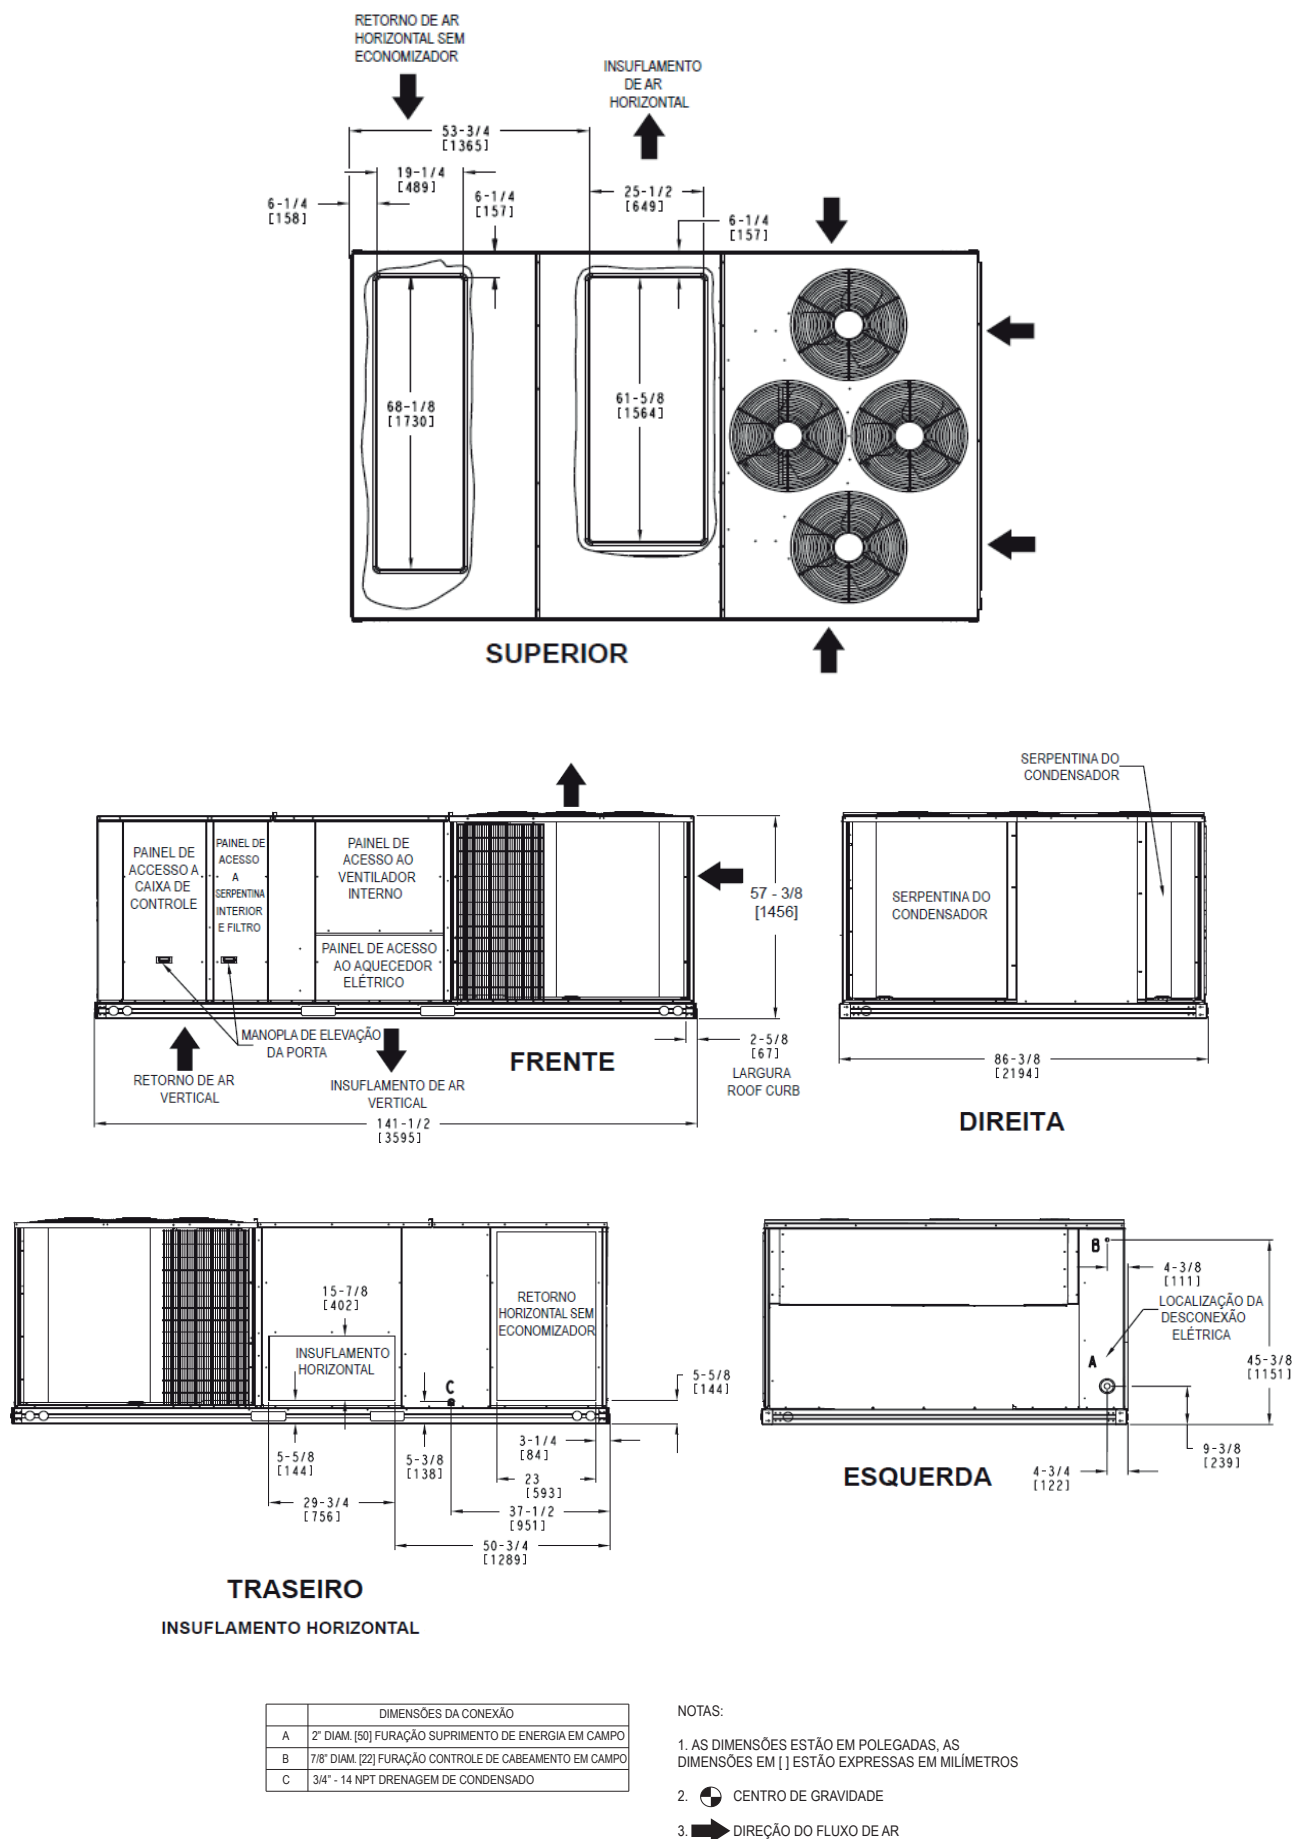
Desenho dimensional da unidade - 50TC_25
